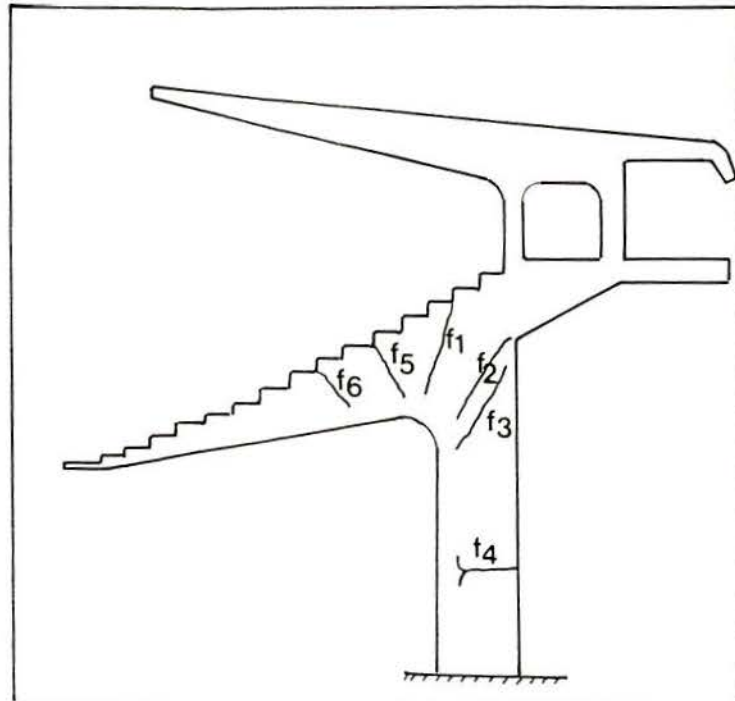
Esquema de fissuras no pórtico 3 para 16 KN.
